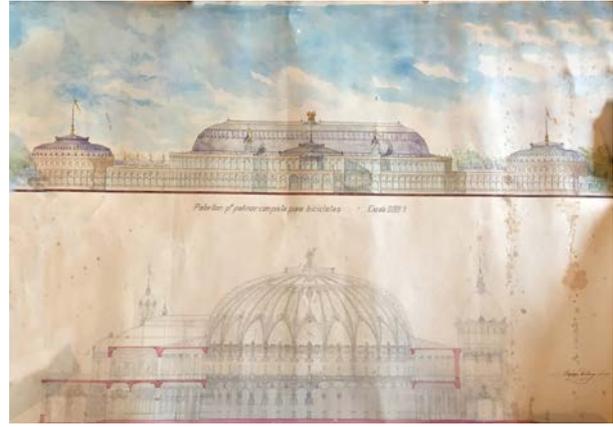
Mariano Estanga: Pabellón para patinar con pista para bicicletas. Perspectiva y sección. c. 1897.
